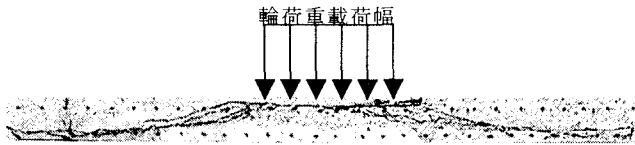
押し抜き破壊状況(供試体2, 橋軸直角方向断面)
